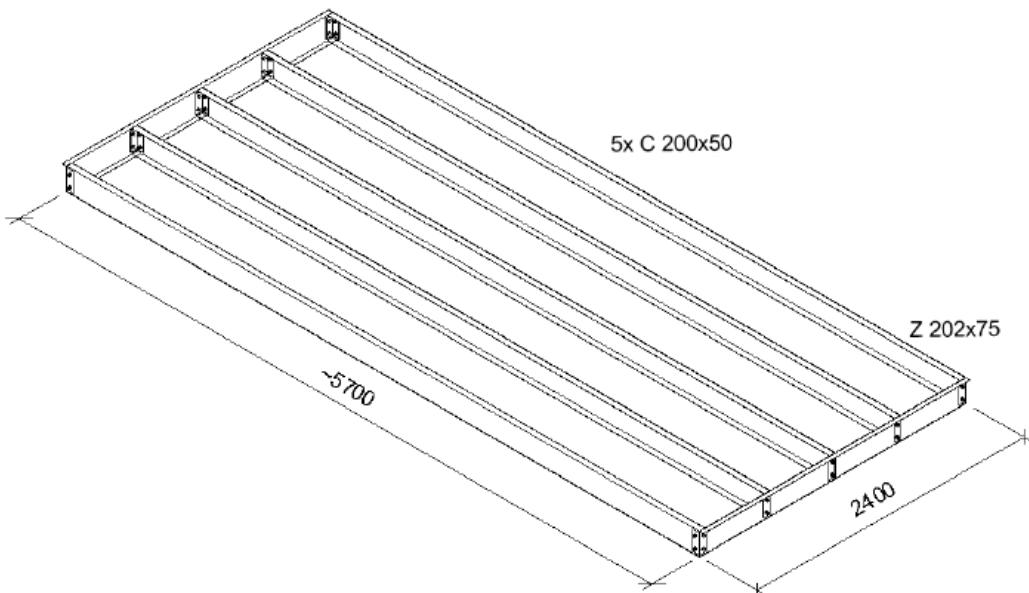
Cassette légère en acier utilisée dans la construction de toits préfabriqués pour un espacement de 6 m entre les poutres (moins la largeur nominale de la poutre de 300 mm) [5]
